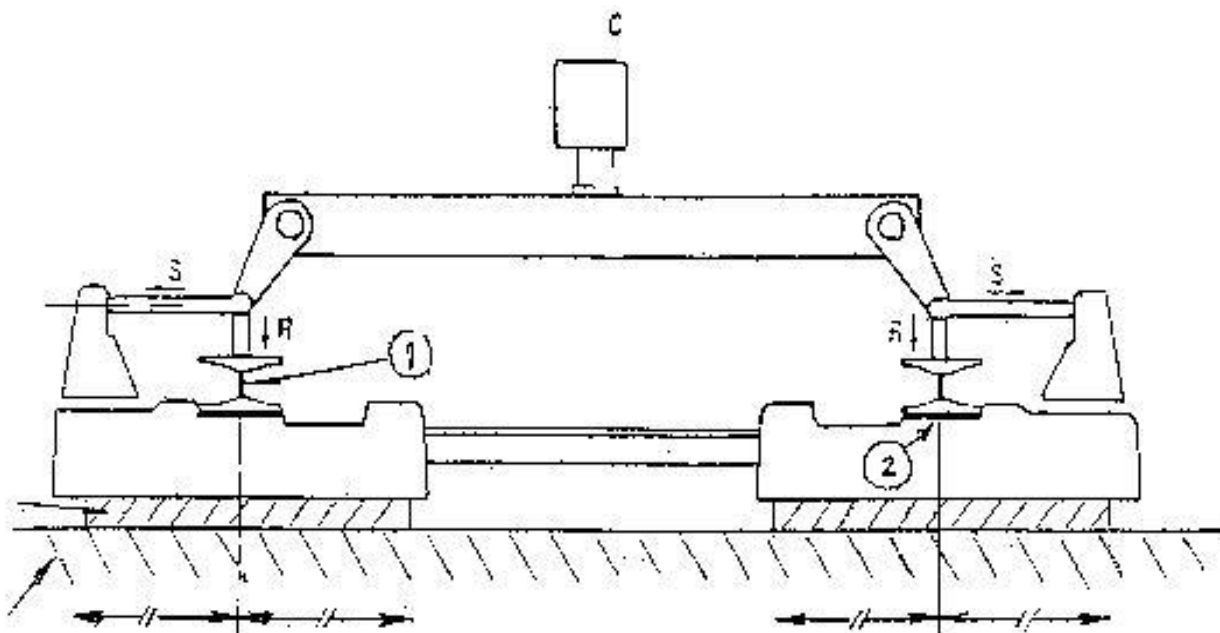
Ensayo de Carga Estática aplicada sobre la pista y el aislador.
